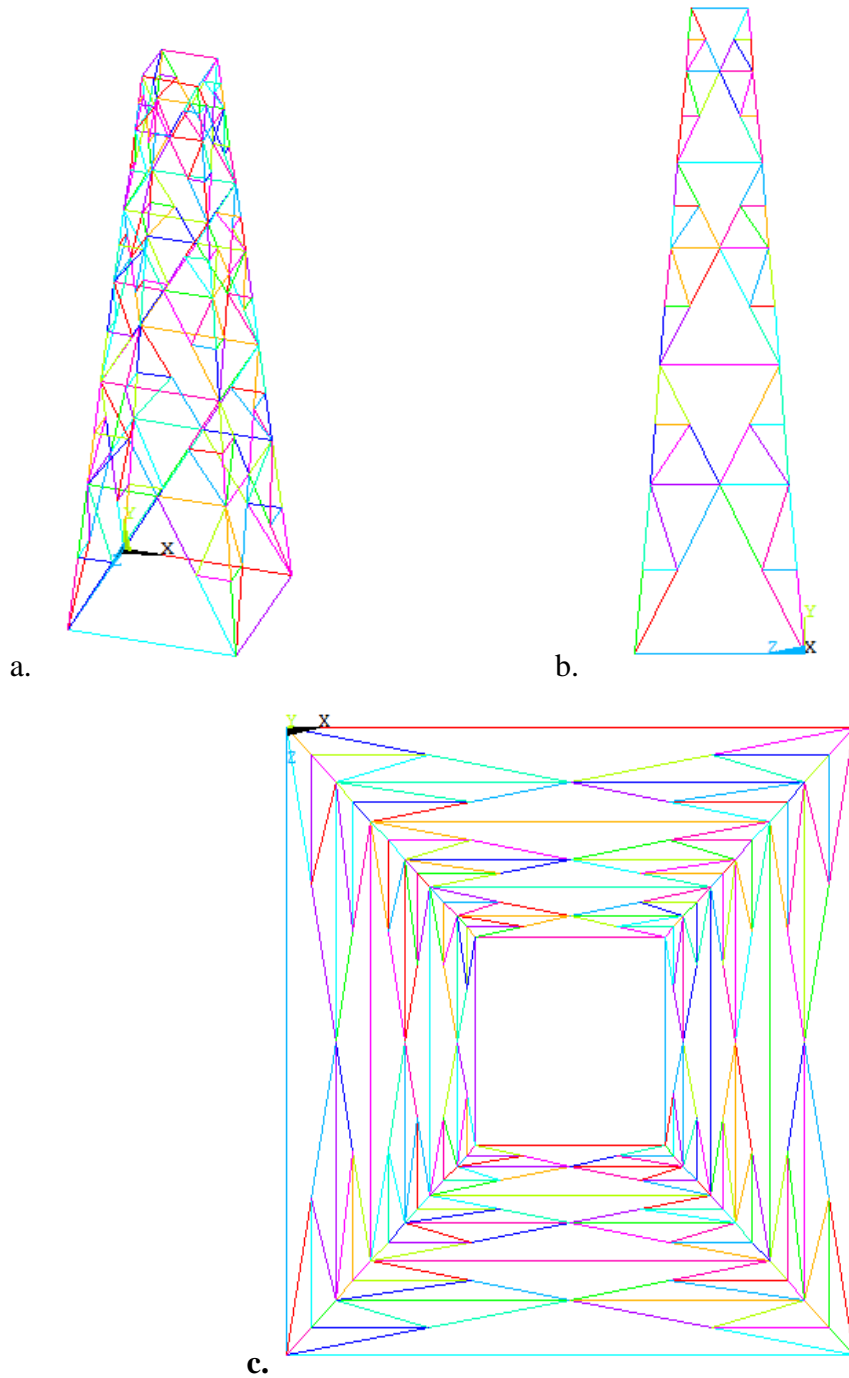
Configuración geométrica de la torre, a. vista isométrica, b. vista frontal, c. vista superior.
